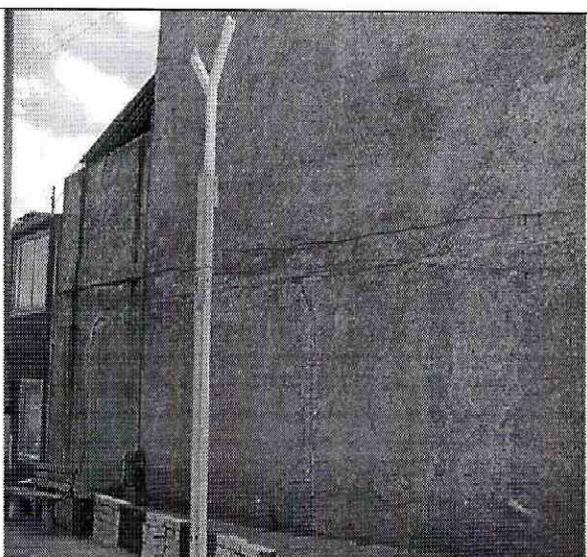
Costado lateral. El muro del patio esta ubicado en la parte superior izquierda. El primer nivel corresponde a un muro de contención.
